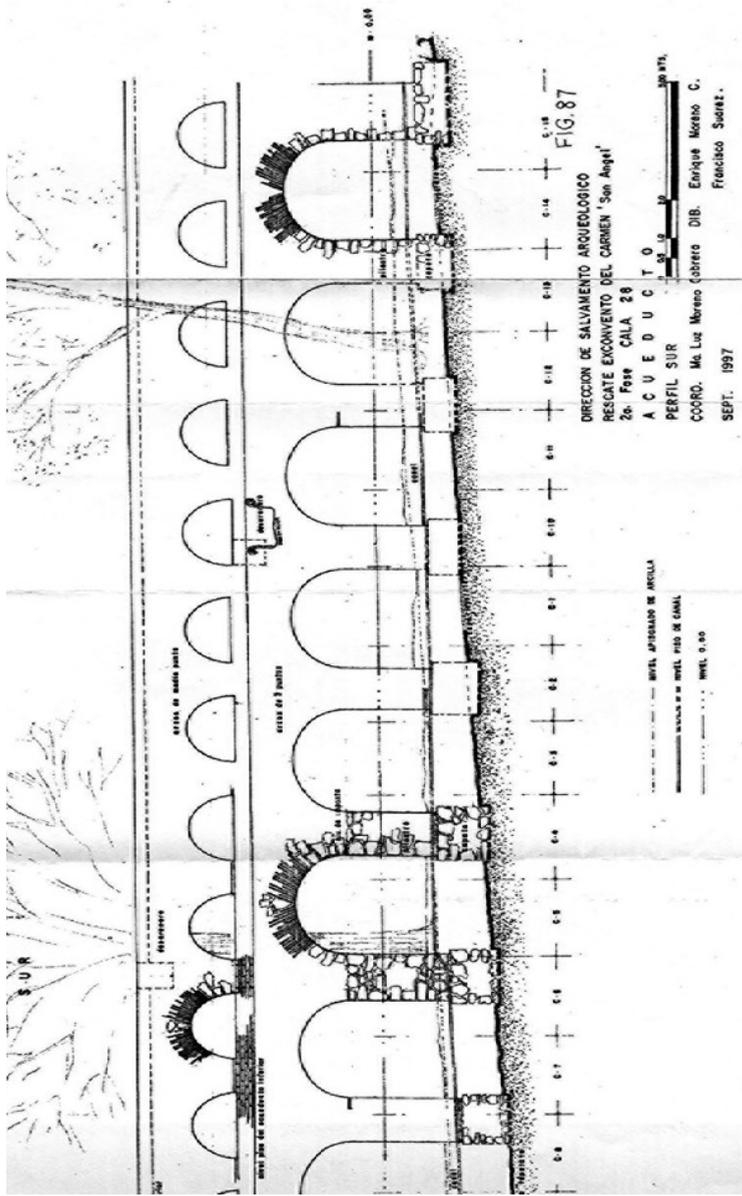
Alzado del acueducto, fachada norte en dirección poniente-orienté, Maria de la Luz Moreno, op. cit., planos de Enrique Moreno 1997.
